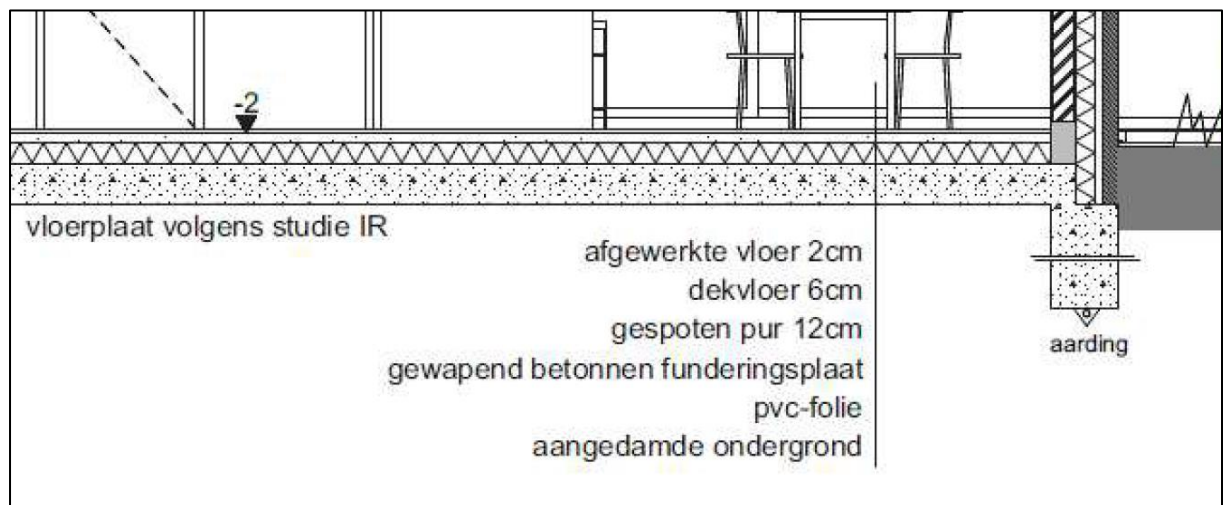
detail uit het doorsnedeplan van de woningen met aanduiding van de funderingsopbouw © architect N. Cornelissen
